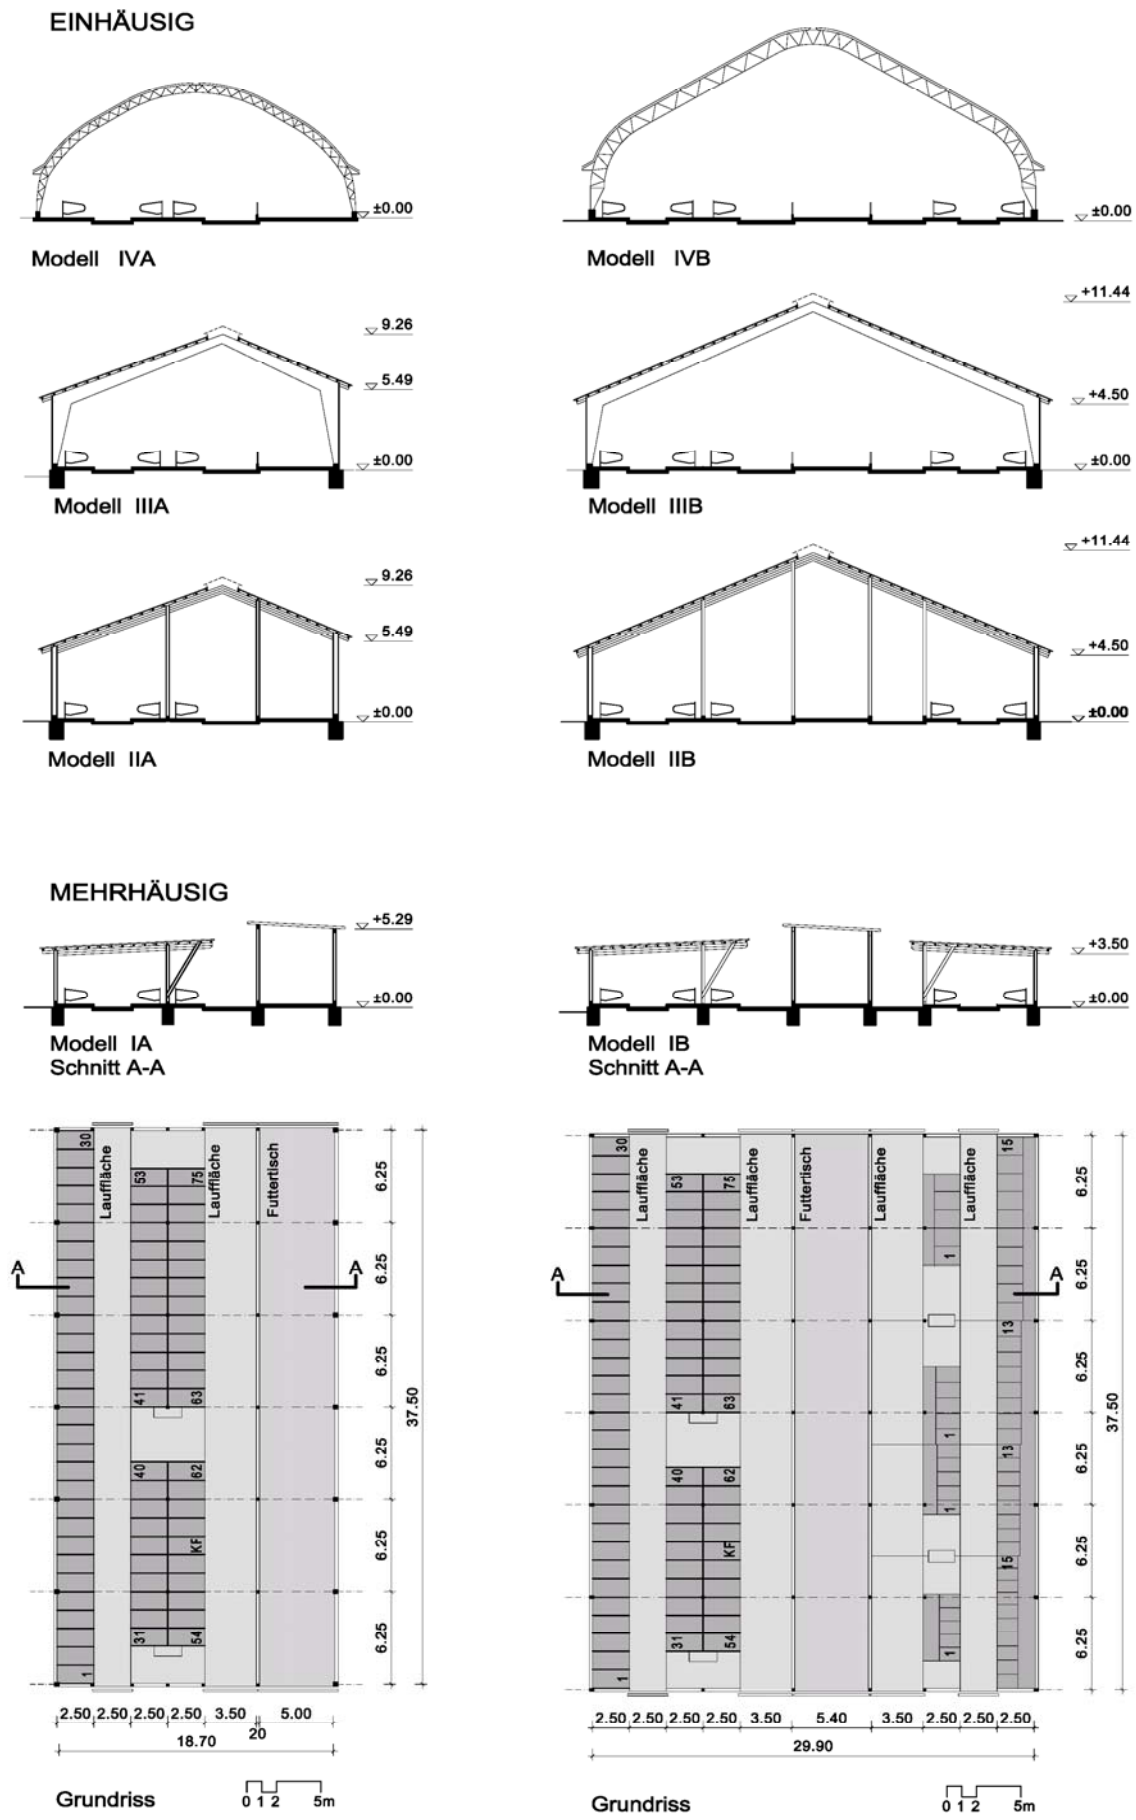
Grundrisse und Schnitte für die Stallmodelle I - IV
